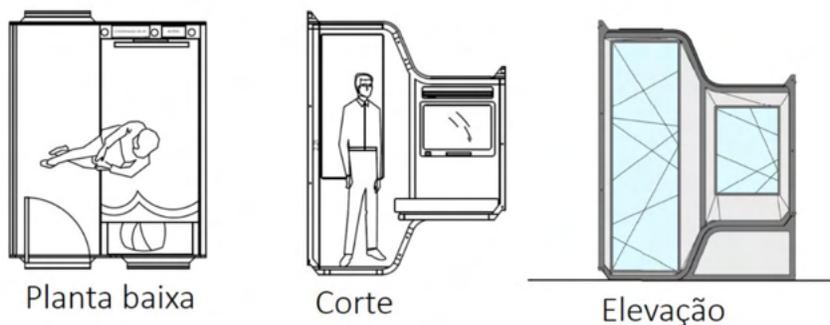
Planta Baixa, Corte e Elevação do Módulo individual
